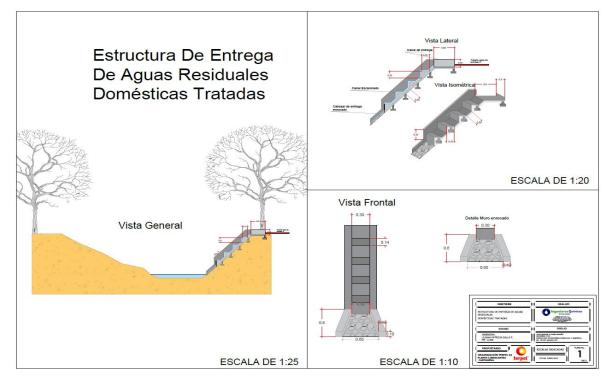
Plano general de estructura de entrega de ARD de la planta de TERPEL S.A.
